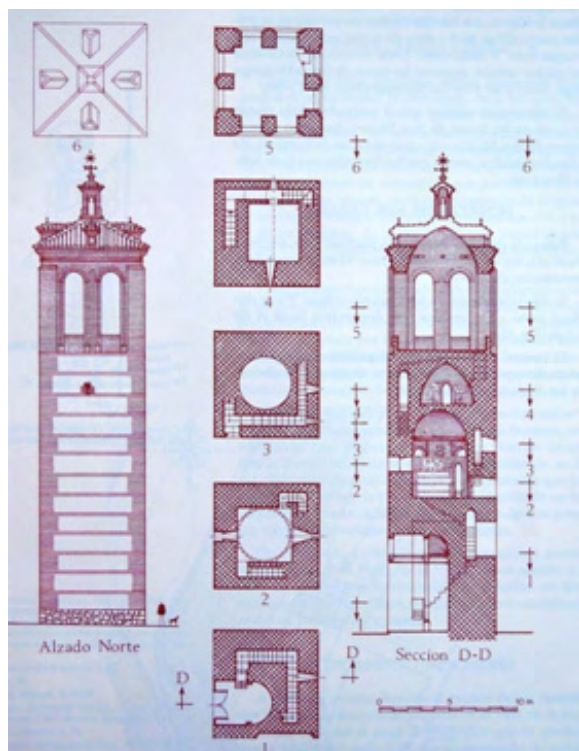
Torre de El Salvador. Plantas alzados y sección aportados por Luis Cervera Vera. Representación del estado correspondiente al año 1992.
